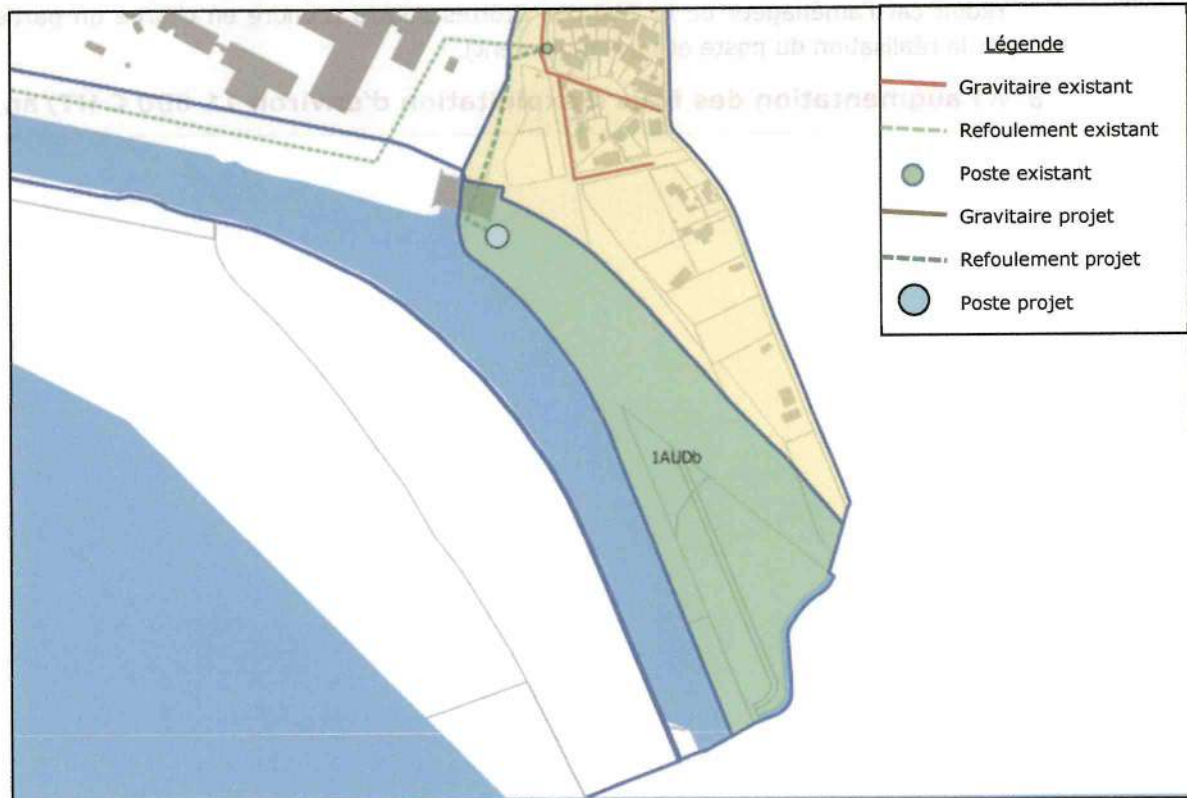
Proposition de raccordement du secteur du Pont du Roy sud
